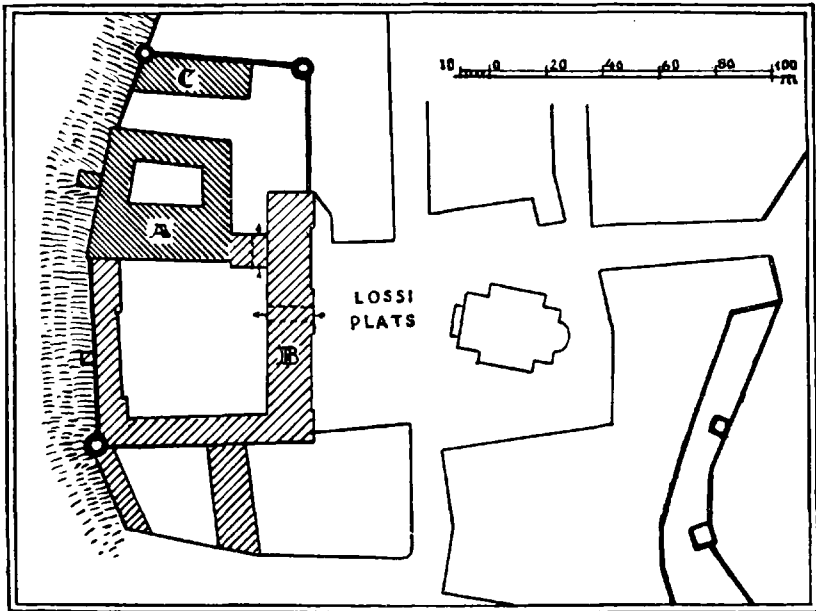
Grundriss der Tallinner Burg vor 1935.
